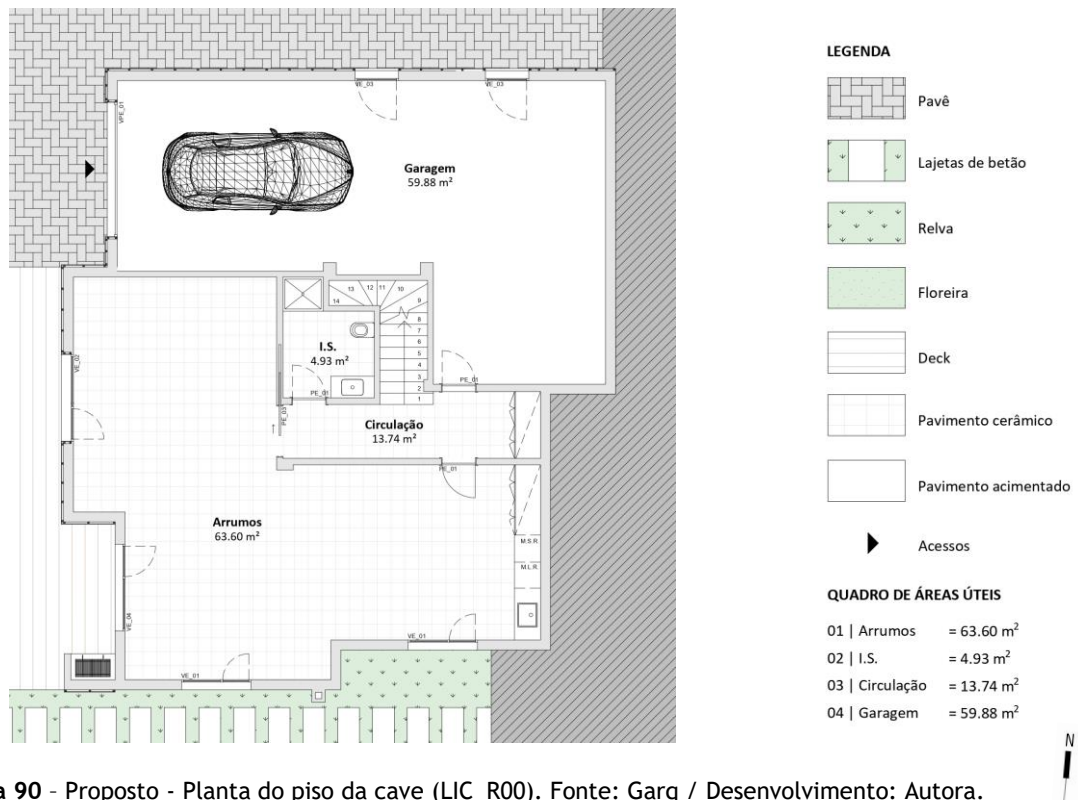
Proposto - Planta do piso da cave (LIC_R00). Fonte: Garq / Desenvolvimento: Autora.
